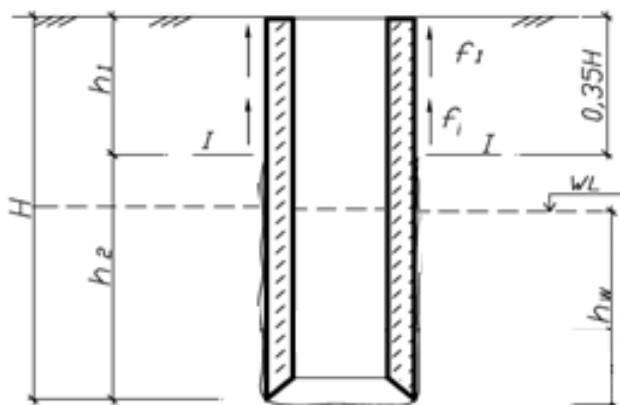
Схема к расчету опускного колодца на разрыв
